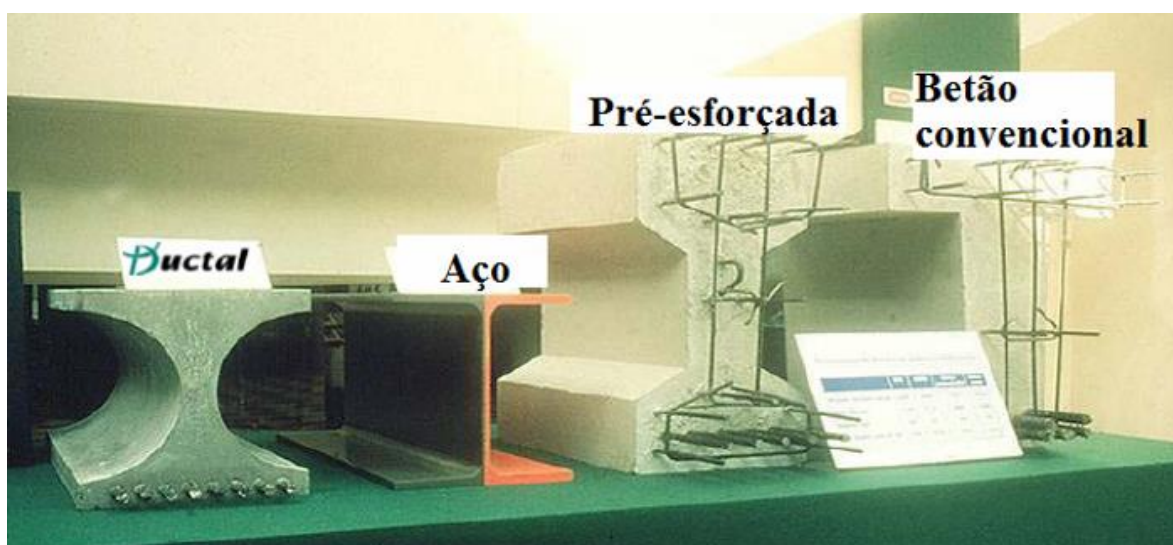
Viga em UHPC, Aço, Betão Pré-Esforçada e Betão Armado (Devin e Harris, 2010)
